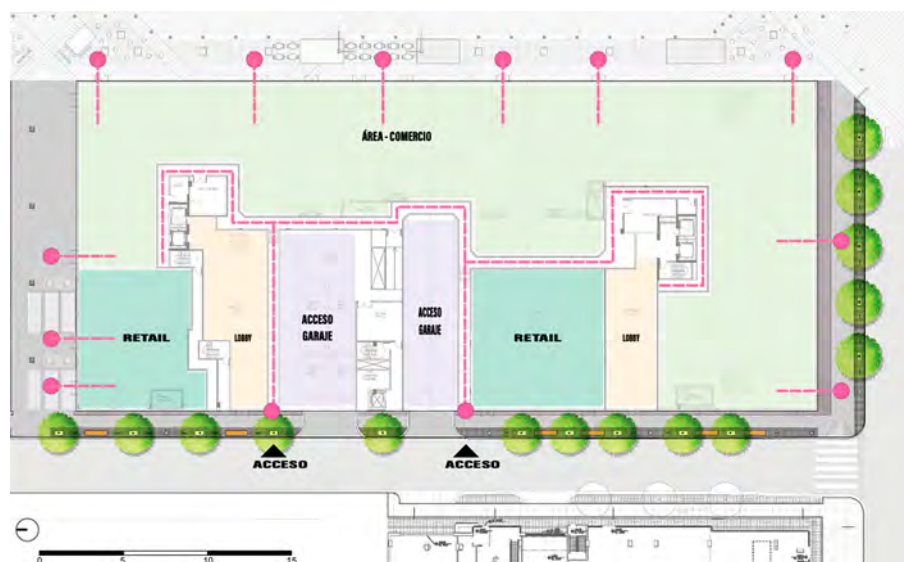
Relación de Planta Baja del Conjunto Habitacional West Half Street con el Contexto
